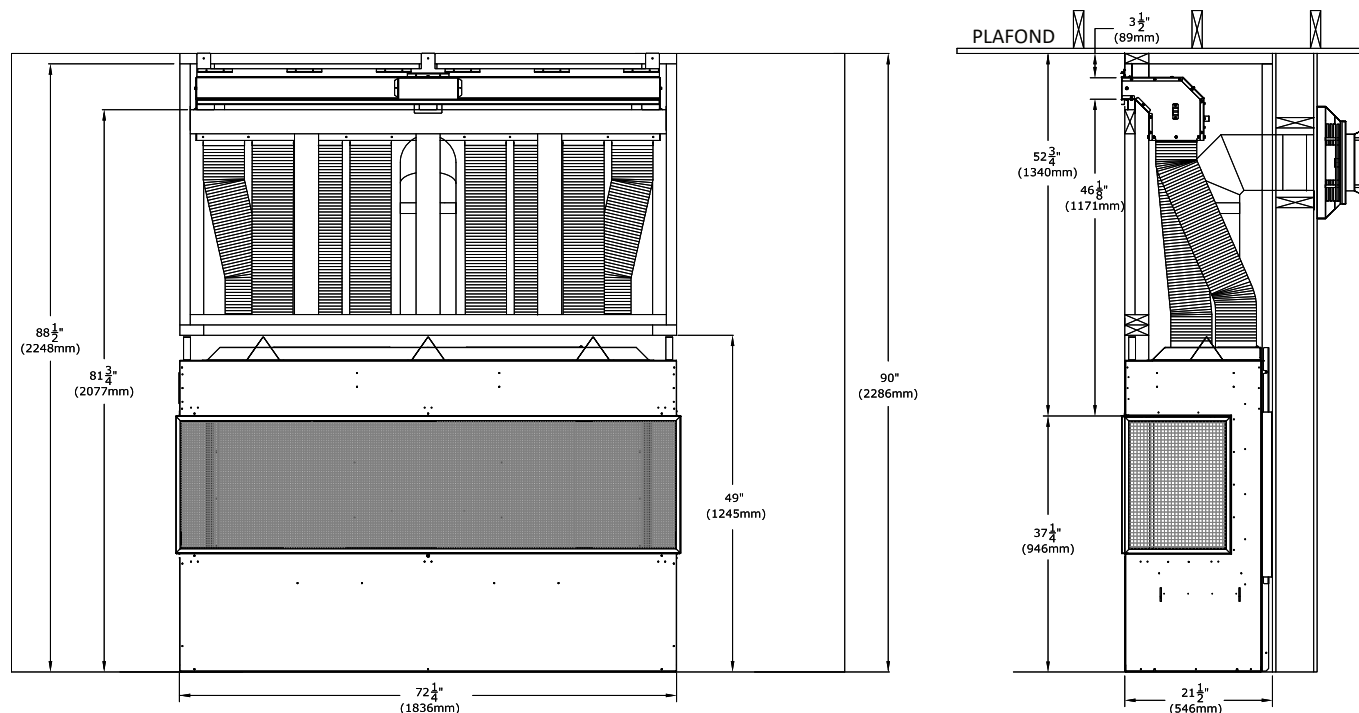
Encadrement du plénum (enceinte de hauteur minimum)
